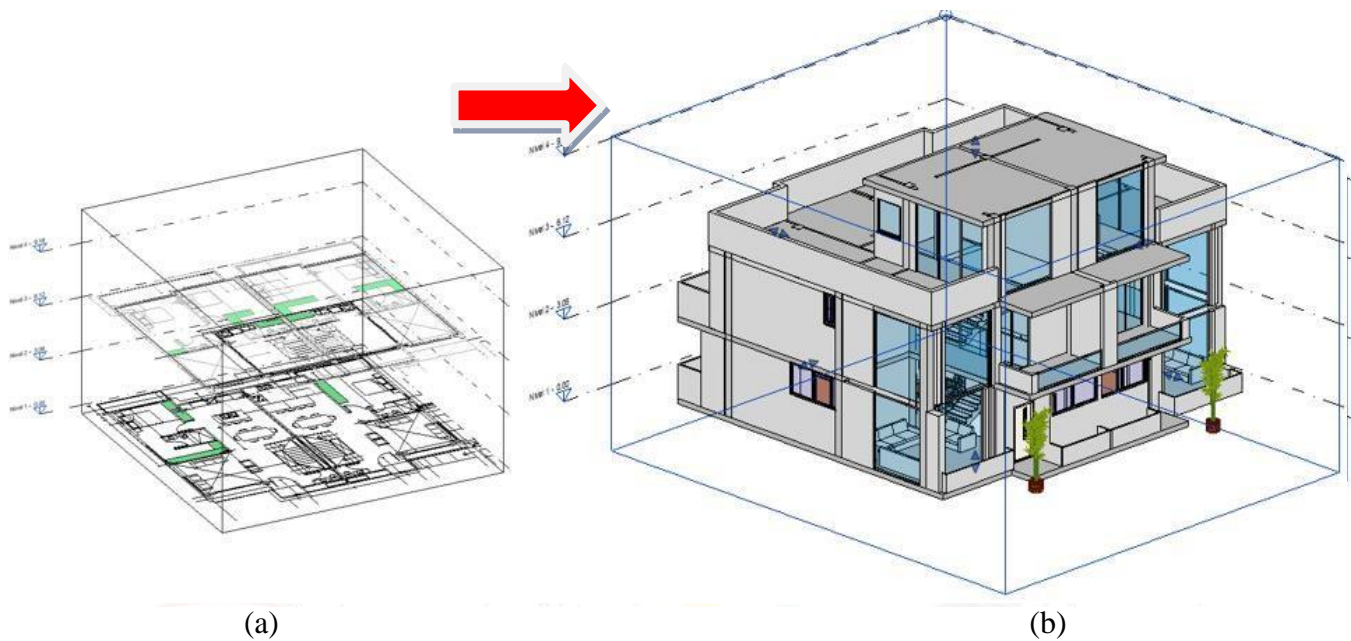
Plano arquitectónico en 2D formato dwg. a) Plano 2D, b) Plano arquitectónico en 3D formato rvt.
